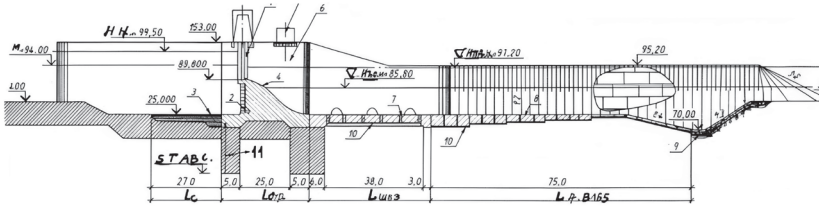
Principales elementos de una presa con vertido incorporado cimentada en suelo.
